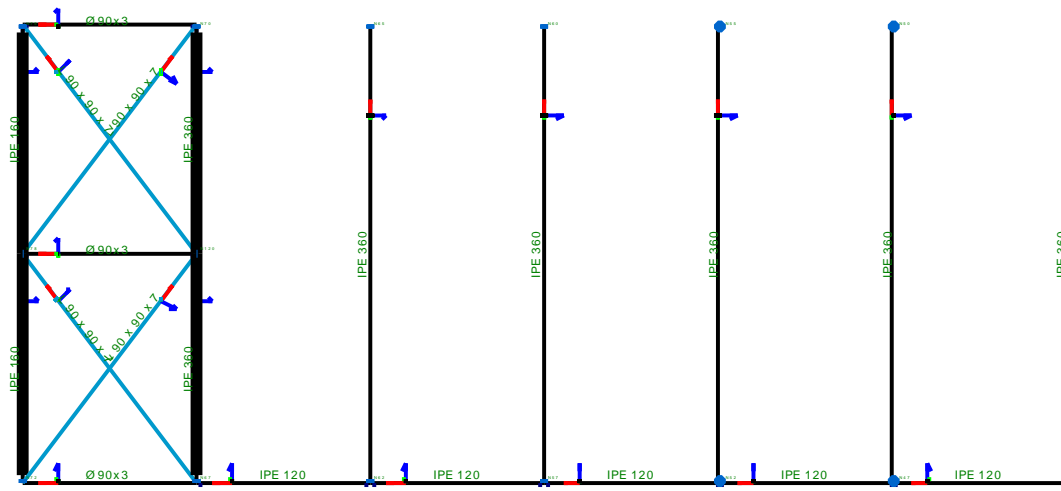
Faldón de la cubierta con detalle de viga contraviento y perimetral
